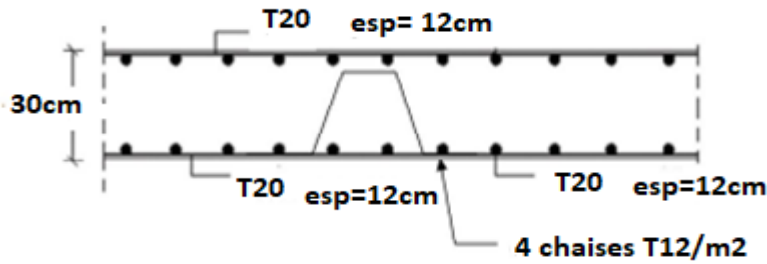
Schéma de ferrailage de la dalle du radier .
